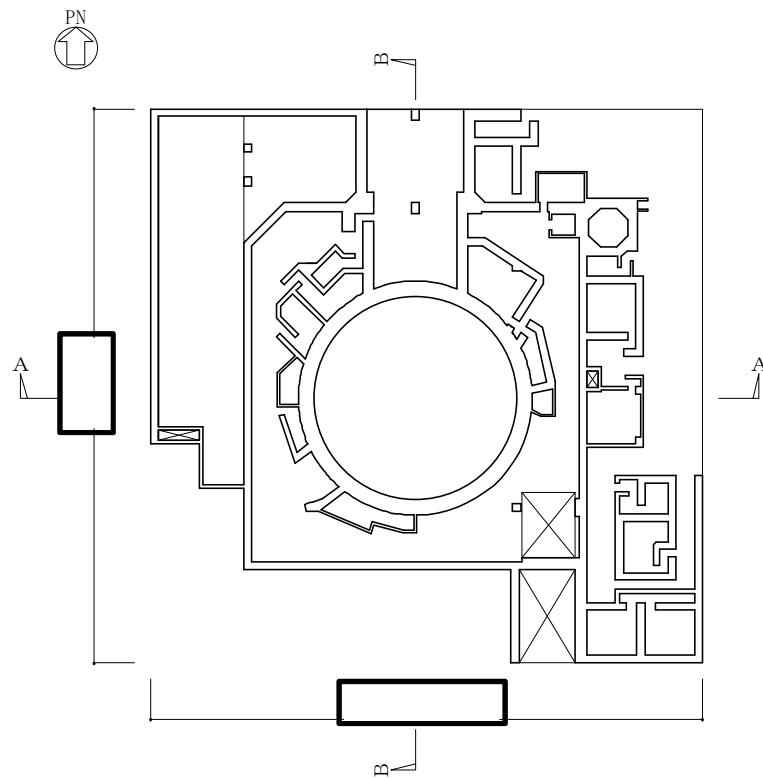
(4/10) 原子炉建屋の概略平面図 (EL. 14.0 m)
